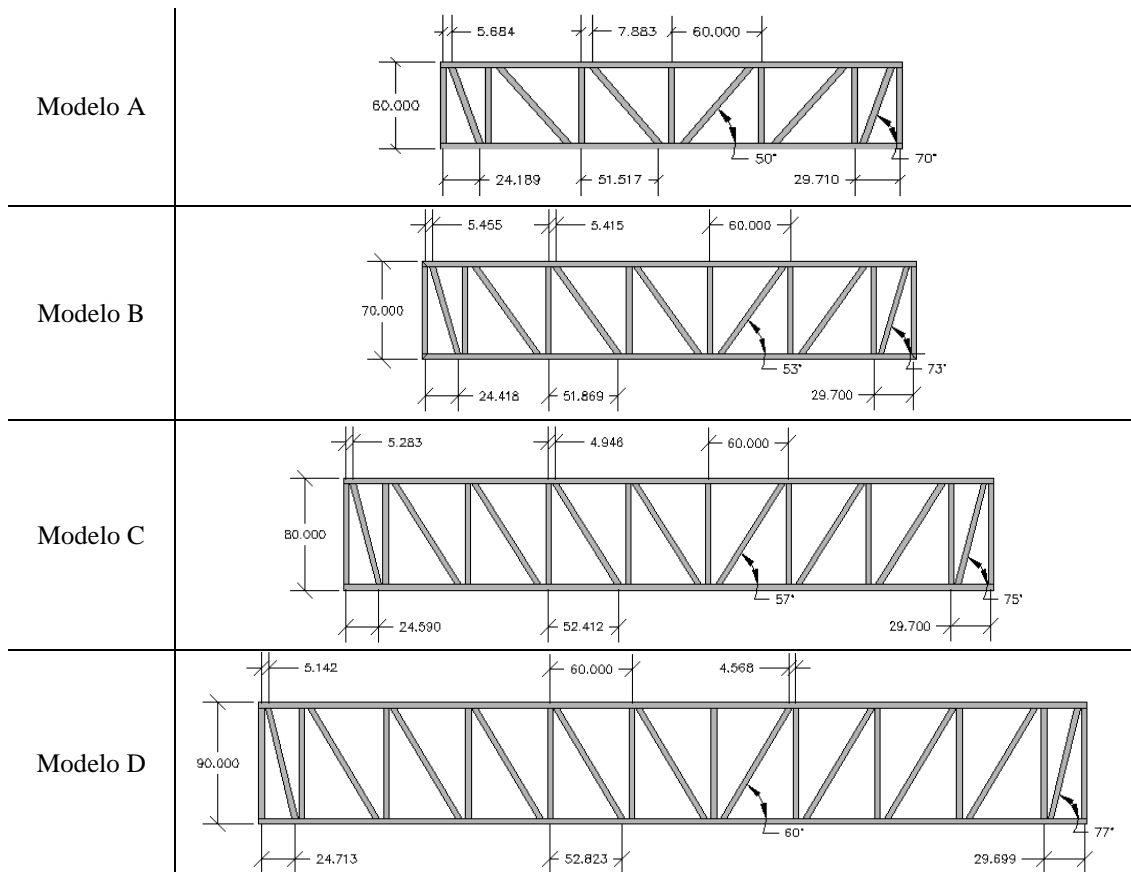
Geometria das vigas-treliça (unidade de medida em cm)
